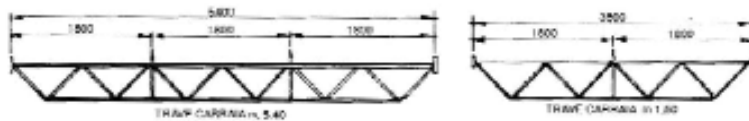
Passo carraio prefabbricato a tre e a due campate
